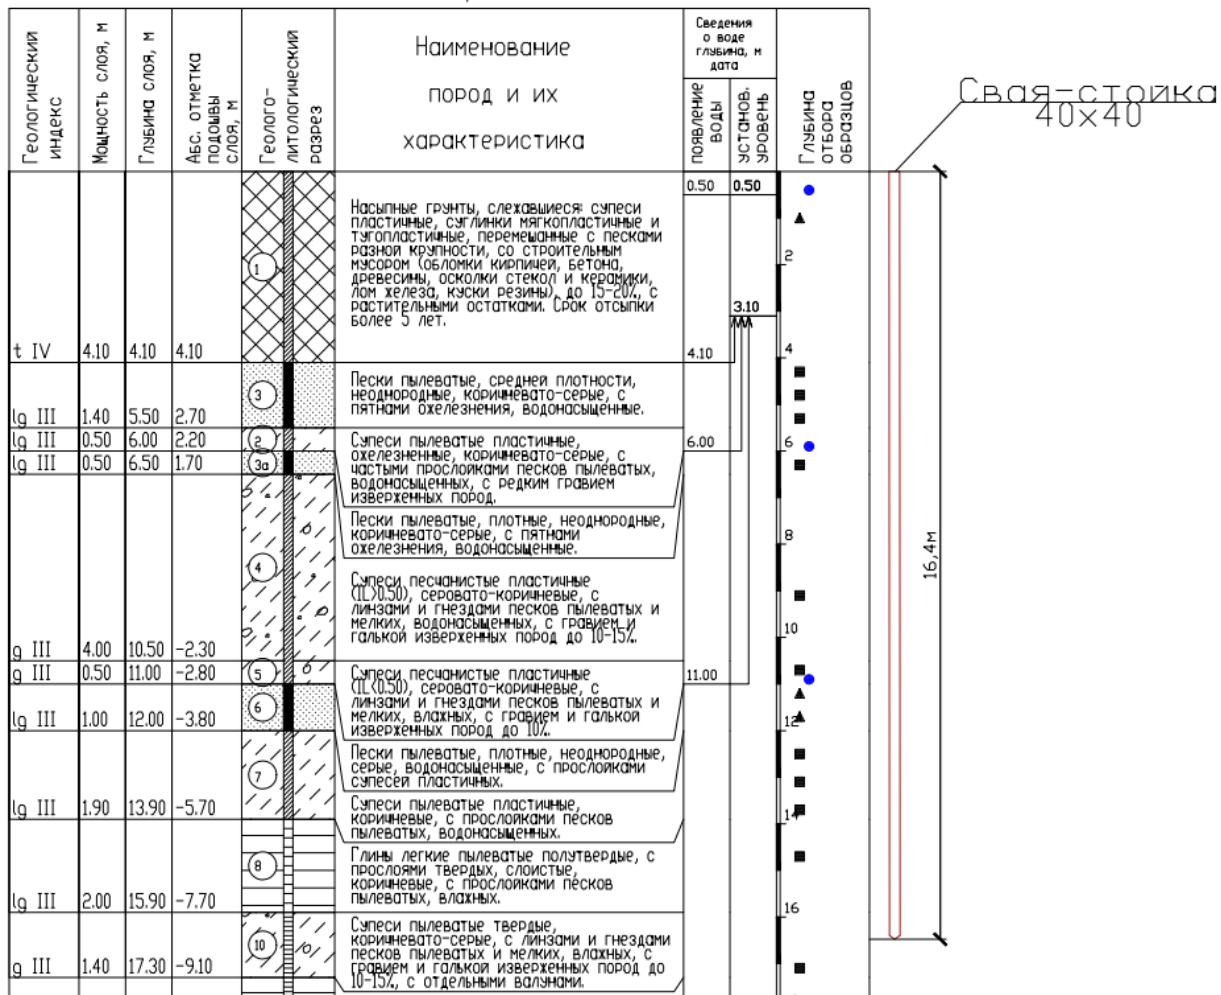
Схема погружения сваи стойки с квадратным сечением размером 40x40 см в грунт на глубину 16,4 м.
